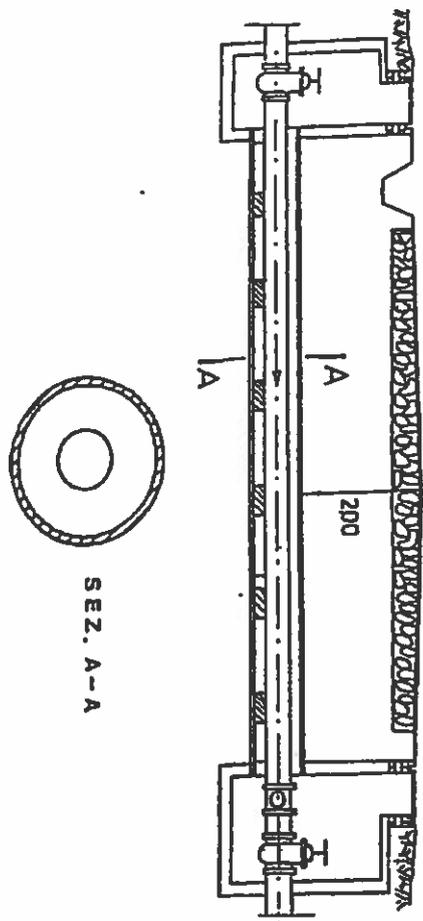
Attraversamento stradale mediante tubo-guaina.
